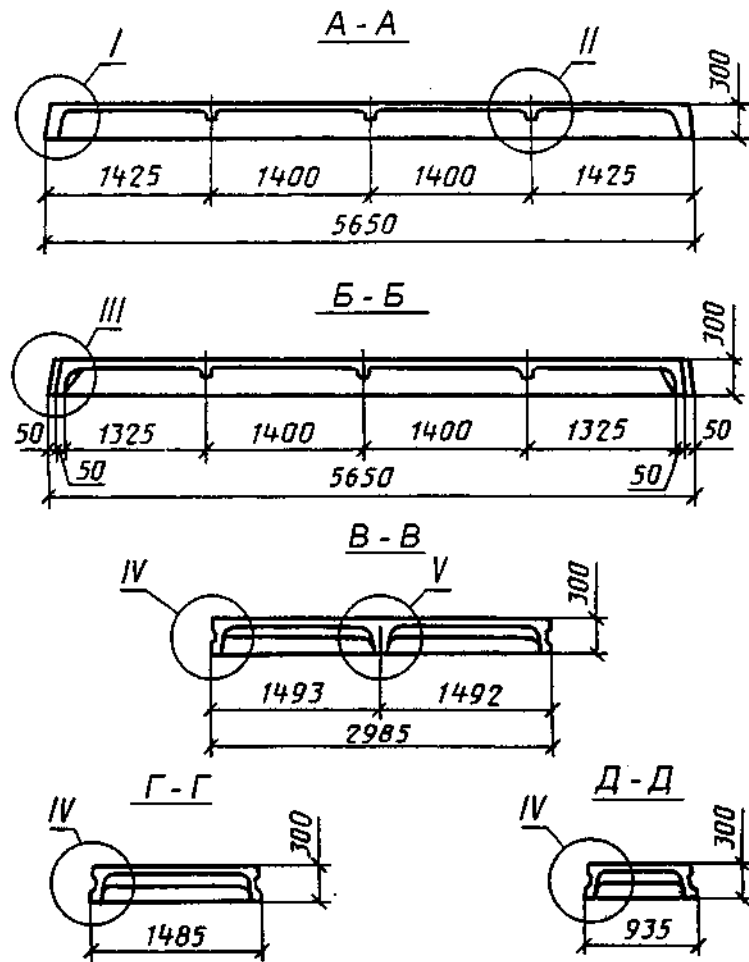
Перерізи залізобетонних ребристих плит перекриттів
